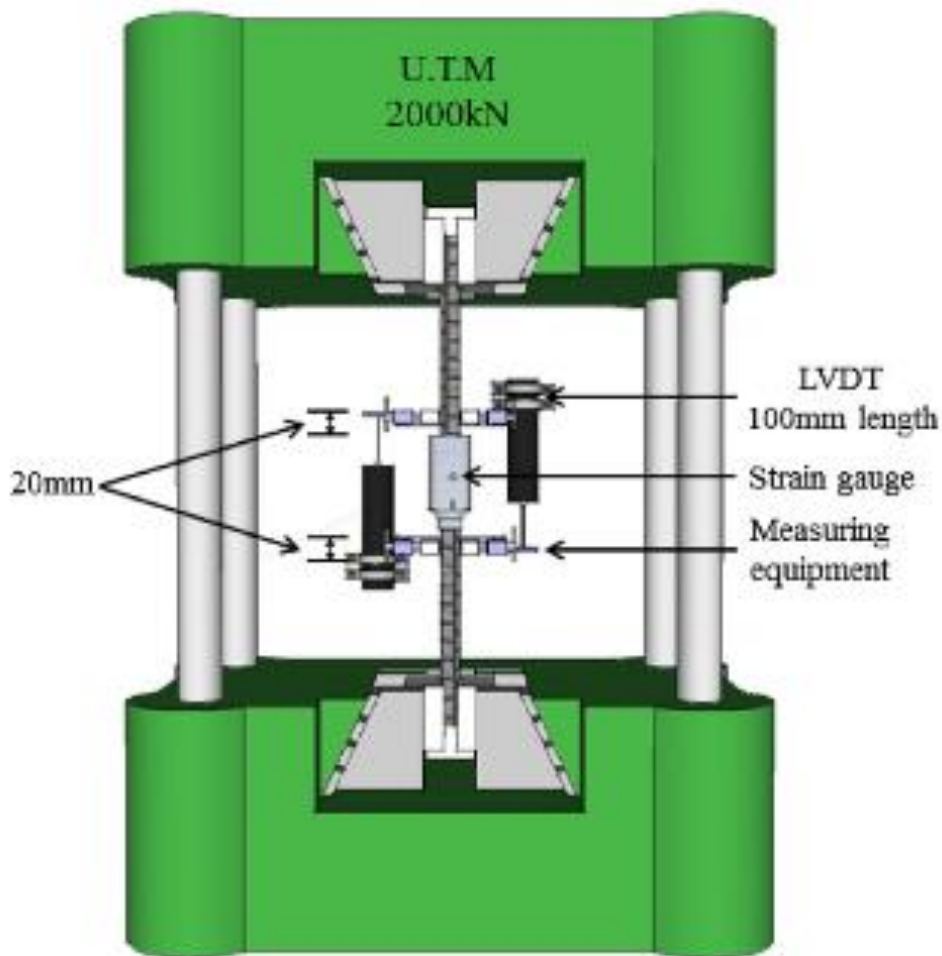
10 : Dispositif d'essai de traction directe sur les barres d'armature [38]
